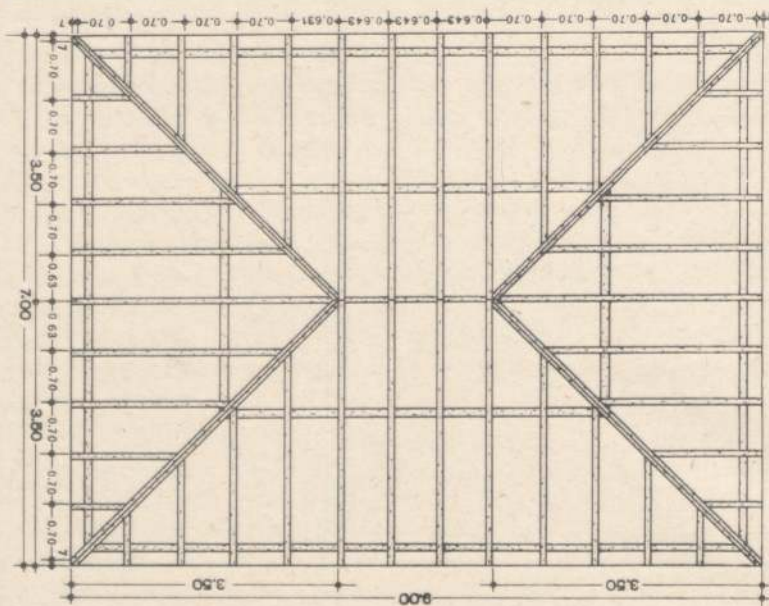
Die Sparrenlage zu dem Walmdach in Abb. 1086.
